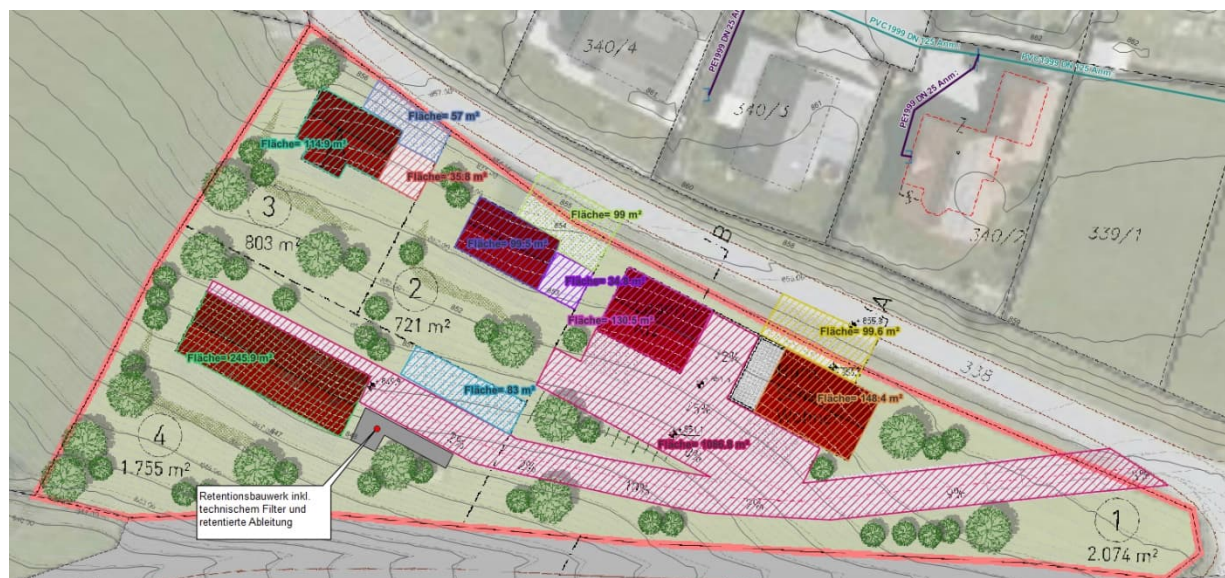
Lageplan Flächen und Lage der Retentionsanlagen
